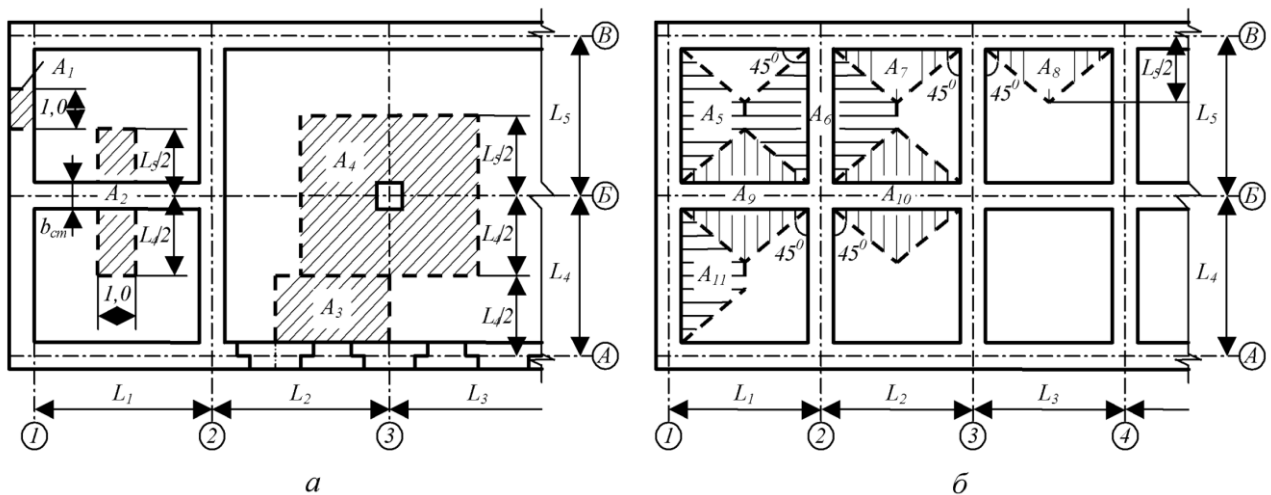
Схема підрахунку навантаження на відповідні вантажні площі, що передають навантаження на уступ фундаменту: *a* – для випадку поздовжніх несучих стін; *б* – для випадку поздовжніх і поперечних несучих стін
